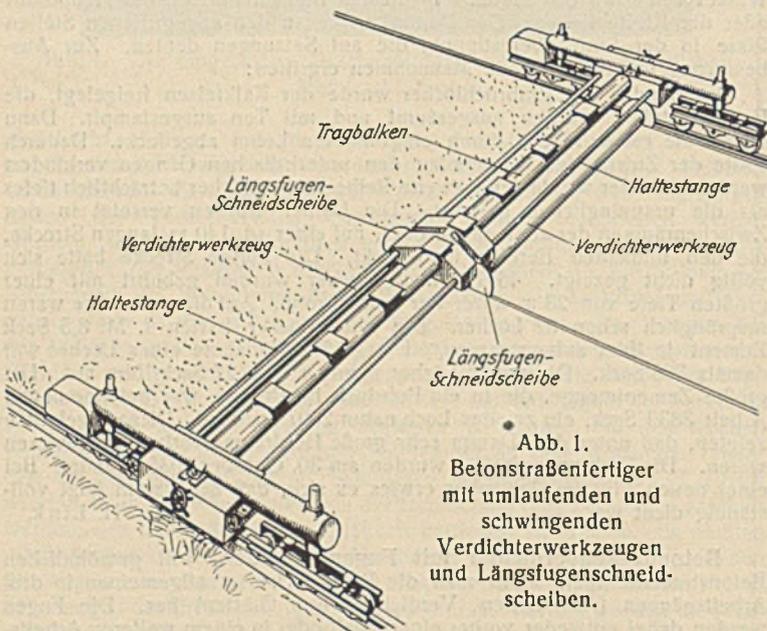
Betonstraßenfertiger mit umlaufenden und schwingenden Verdichterwerkzeugen und Längsfugenschneidscheiben.
